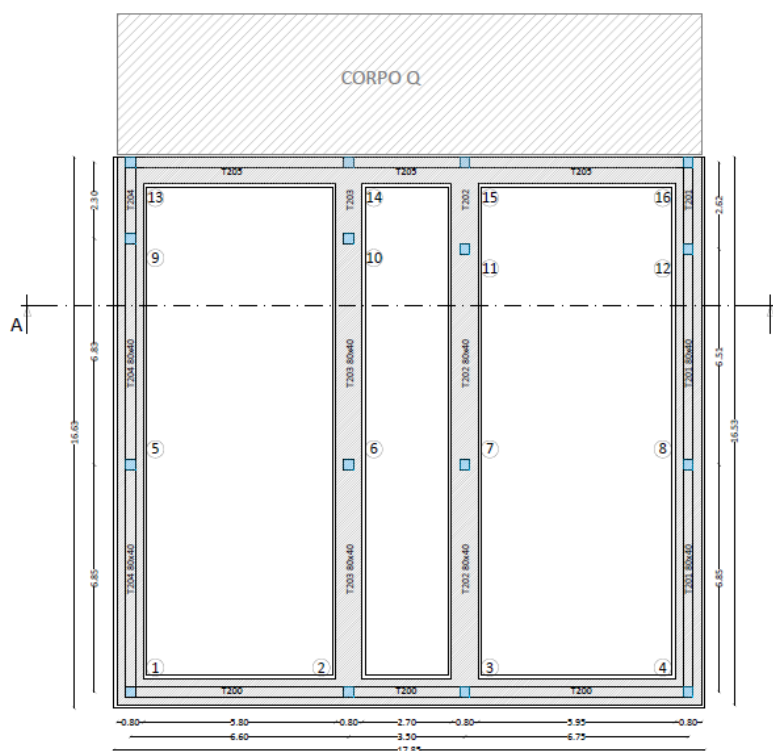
Blocco 4 aule – Planimetria Struttura Fondazione Esistente.
